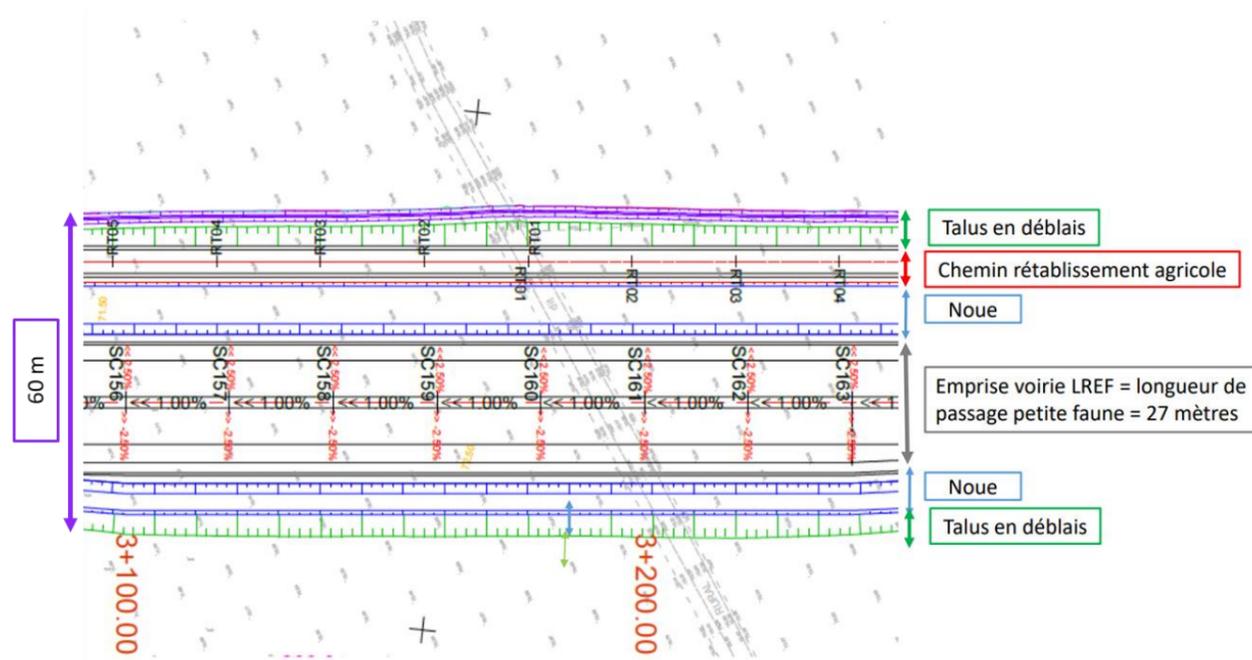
Schéma du barreau routier et positionnement d'un passage à faune (CD77, 2024)
